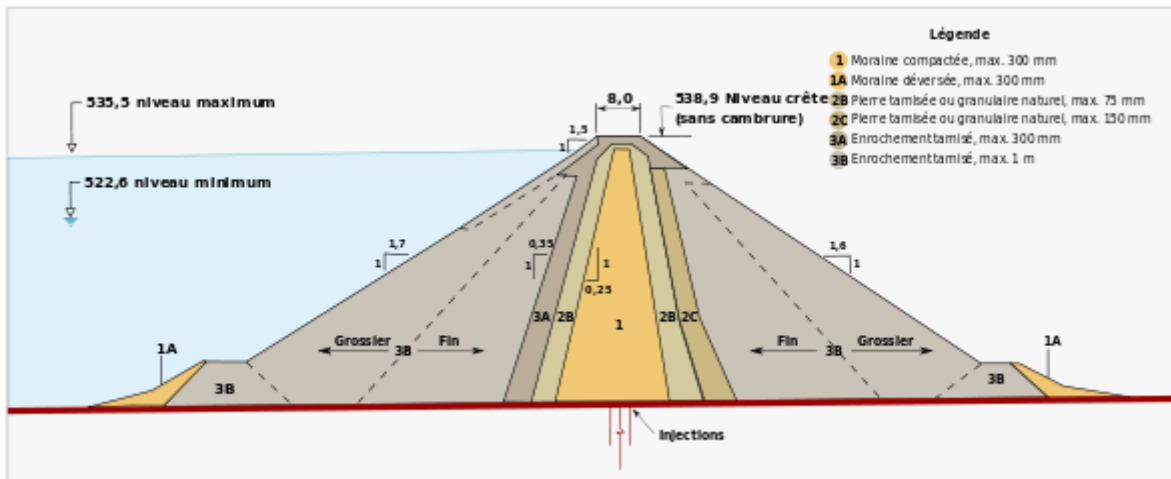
Coupe de profil d'un barrage en remblai (enrochement, digue)
